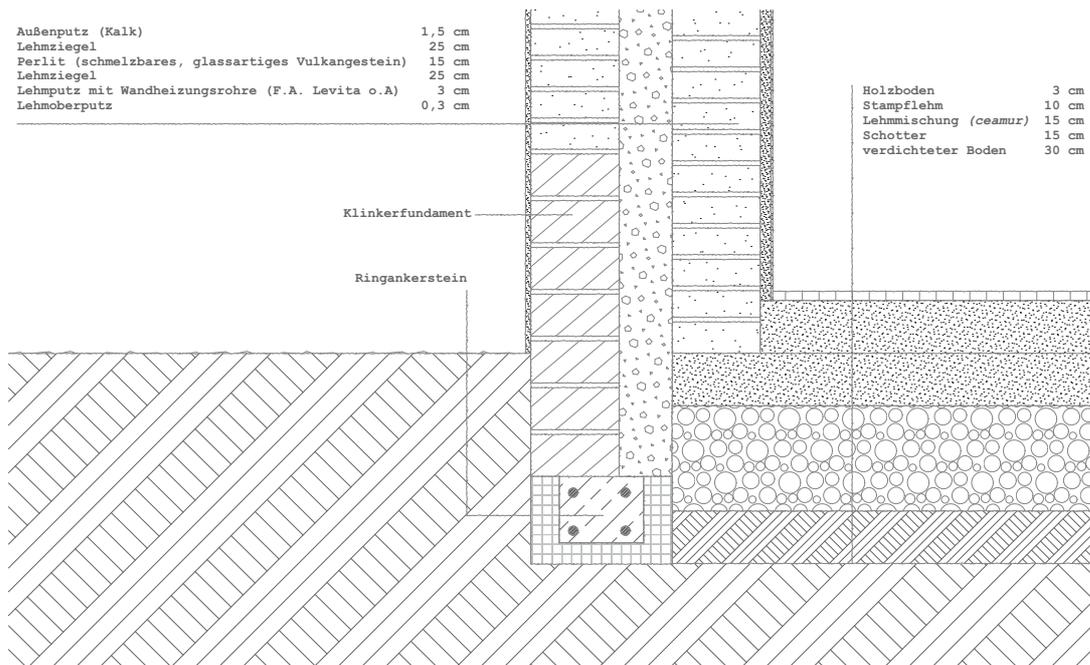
Wohnhaus, Fundamentdetail, Sanierung
